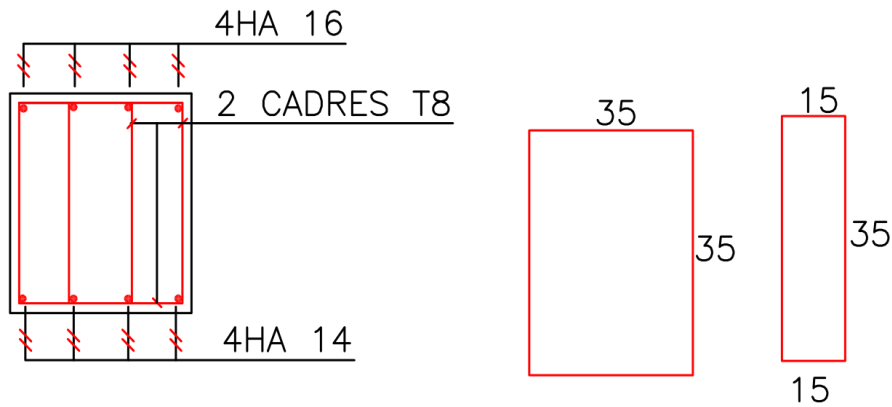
Coupe de ferrailage des poteaux 40×40 cm²
